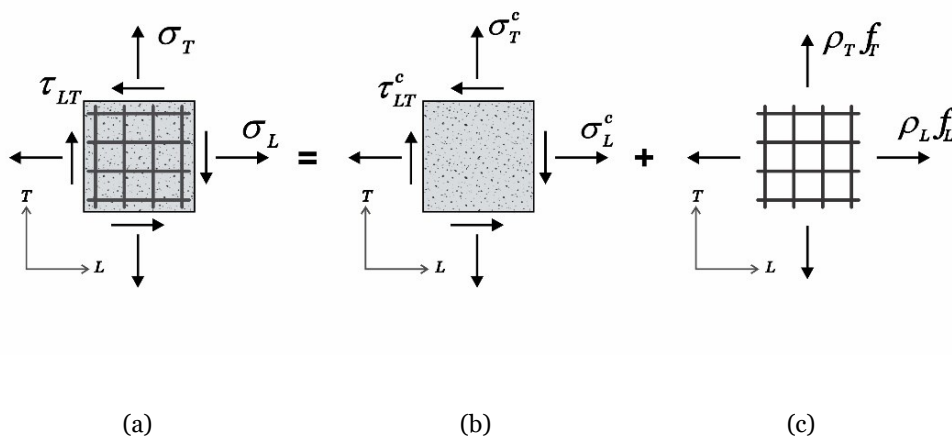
Placa de concreto estrutural submetido a tensões gerais de membrana:
